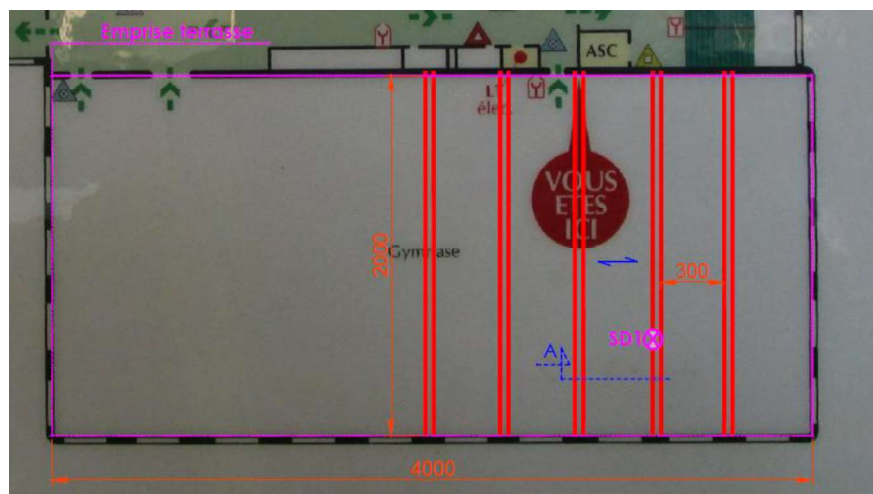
Repérage des sondages sur la vue en plan du R+1 (Terrasse A)
